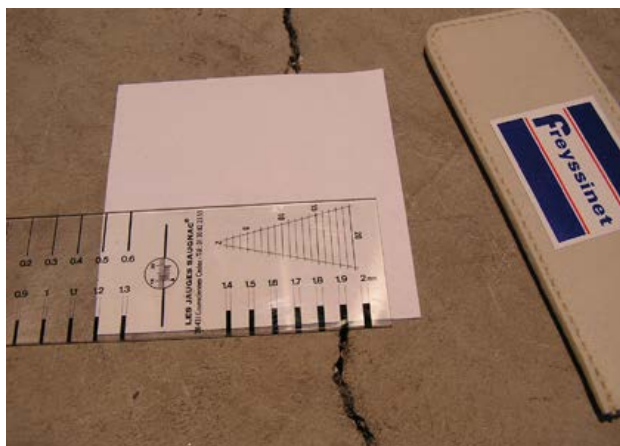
fissure sur une paroi (crédit photo Freyssinet)
